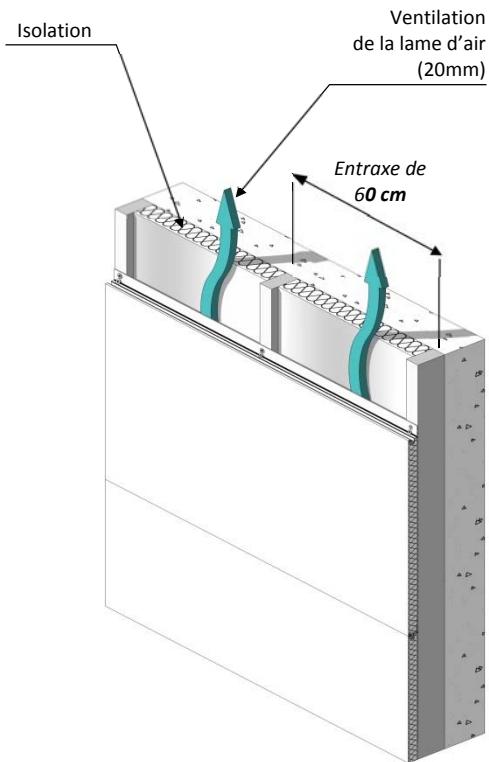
1- Pose en bardage ossature bois simple réseau (lames horizontales) sur mur support béton ou maçonné
